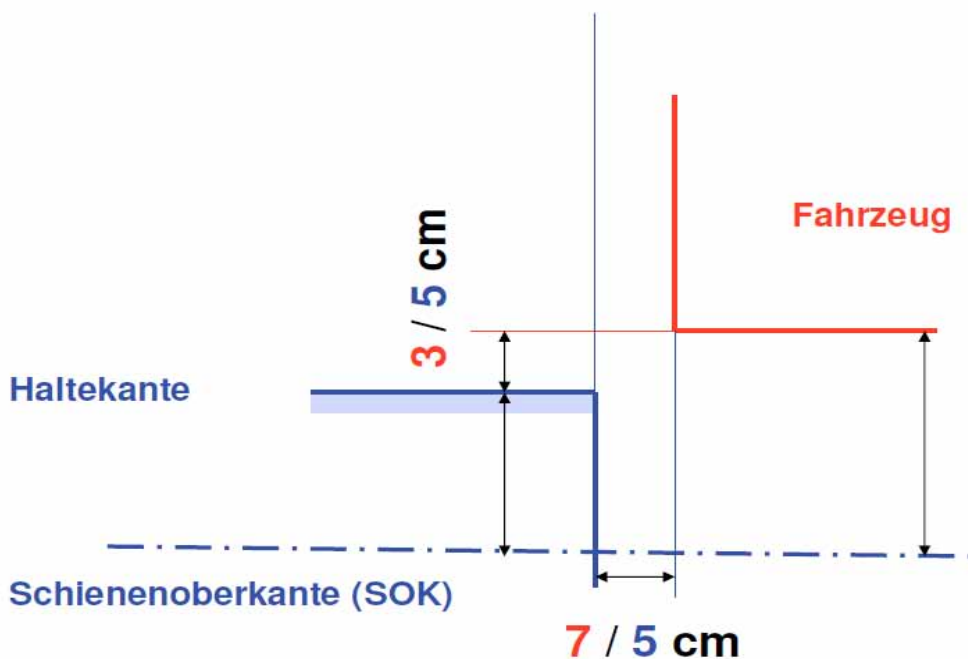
Zu betrachtende Spaltmasse horizontal und vertikal
